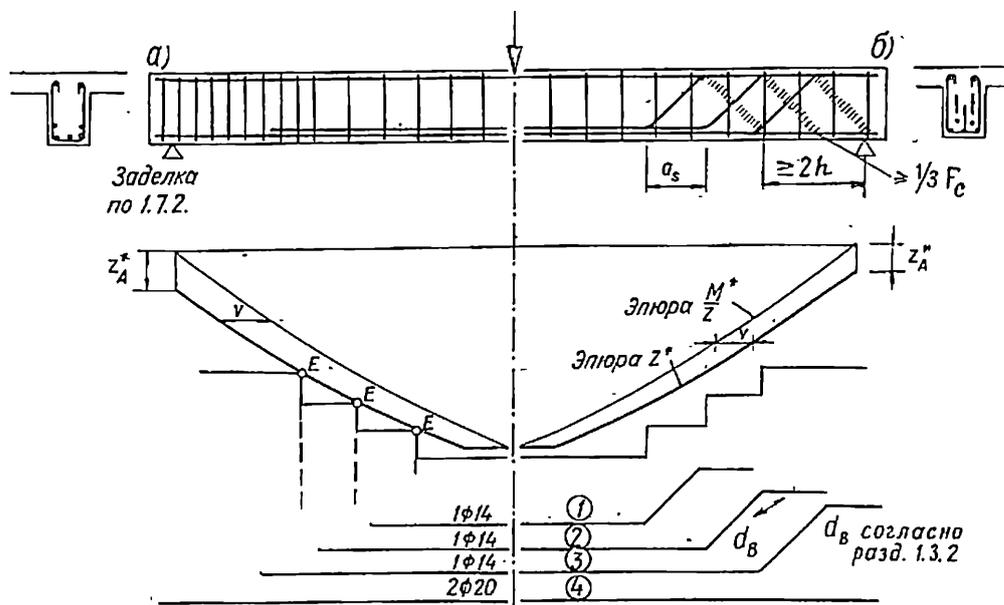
7. Обрыв арматуры в пролете при прямых (а) и отогнутых (б) стержнях
